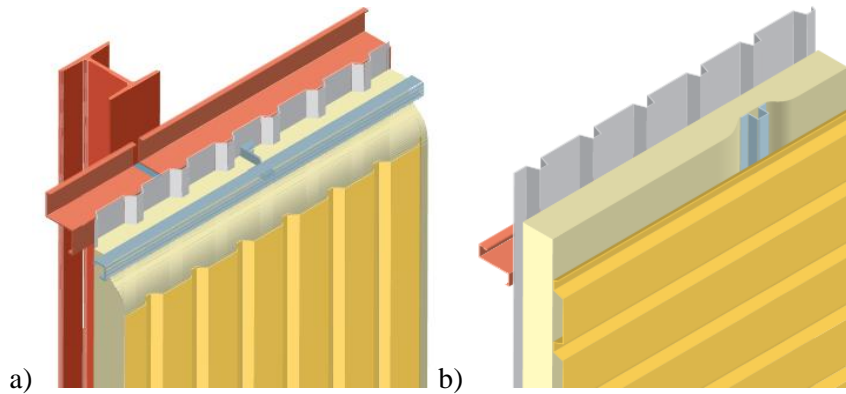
Disposição do sistema: a) Vertical, b) Horizontal [14].
